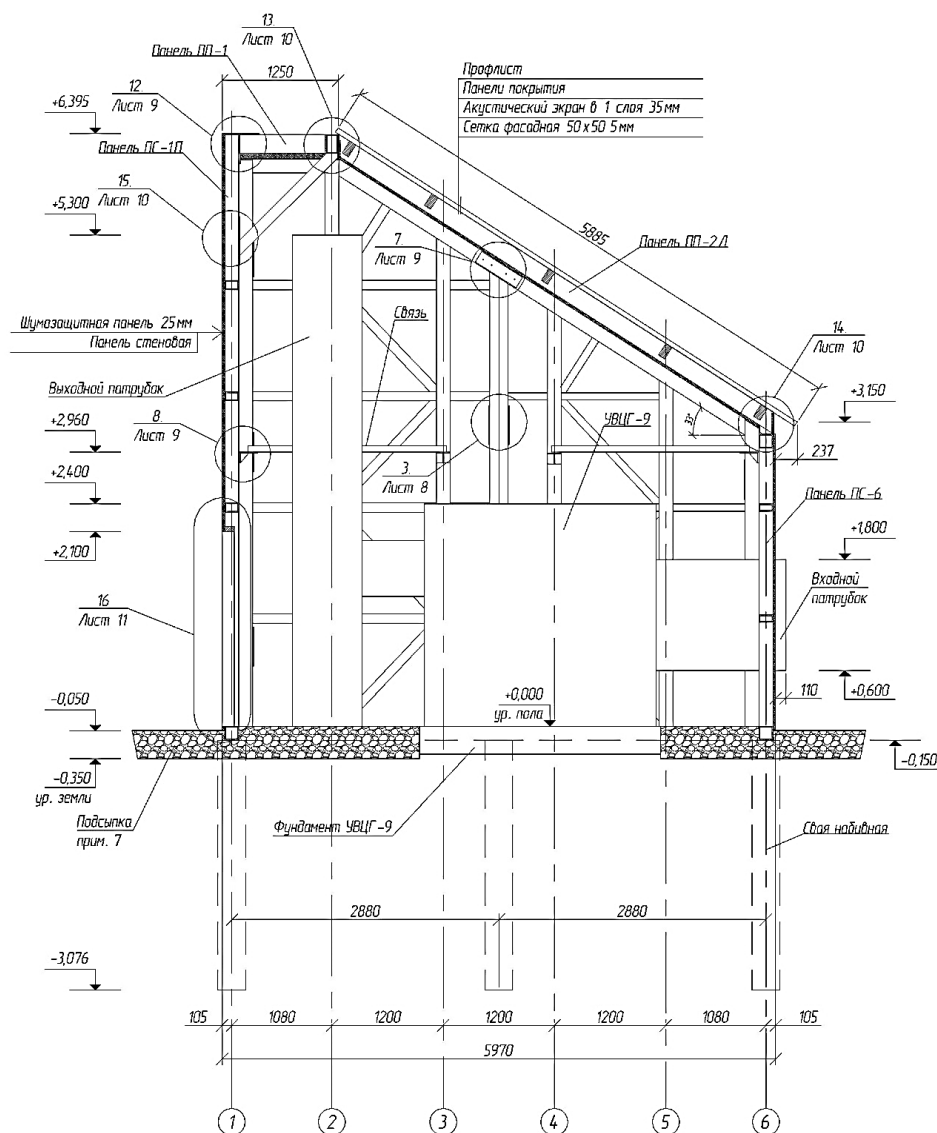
Продольный разрез мобильного укрытия вентиляционной установки УВЦГ-9
